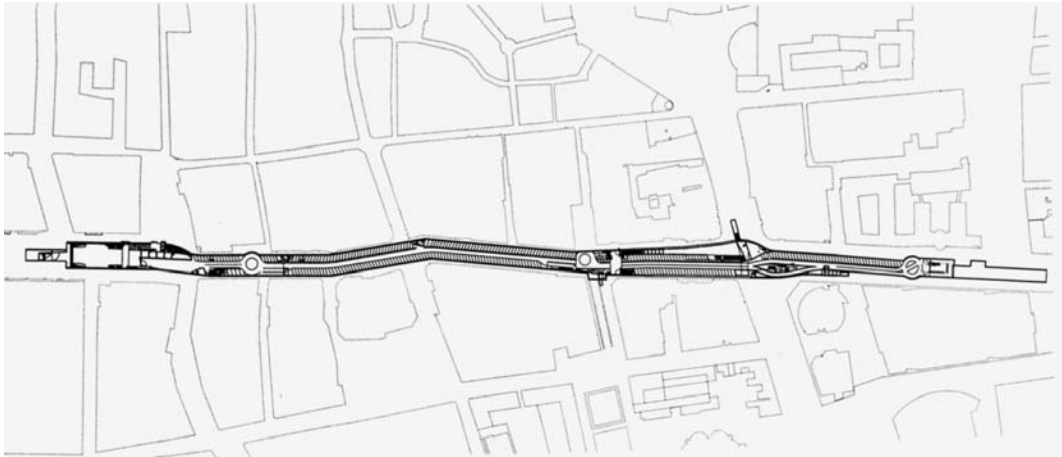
Rem Koolhaas/OMA, Service Tunnel, Den Haag, Niederlande, 1994–2004. Schematischer Lageplan mit Grundriss der Tiefgaragenebene.
